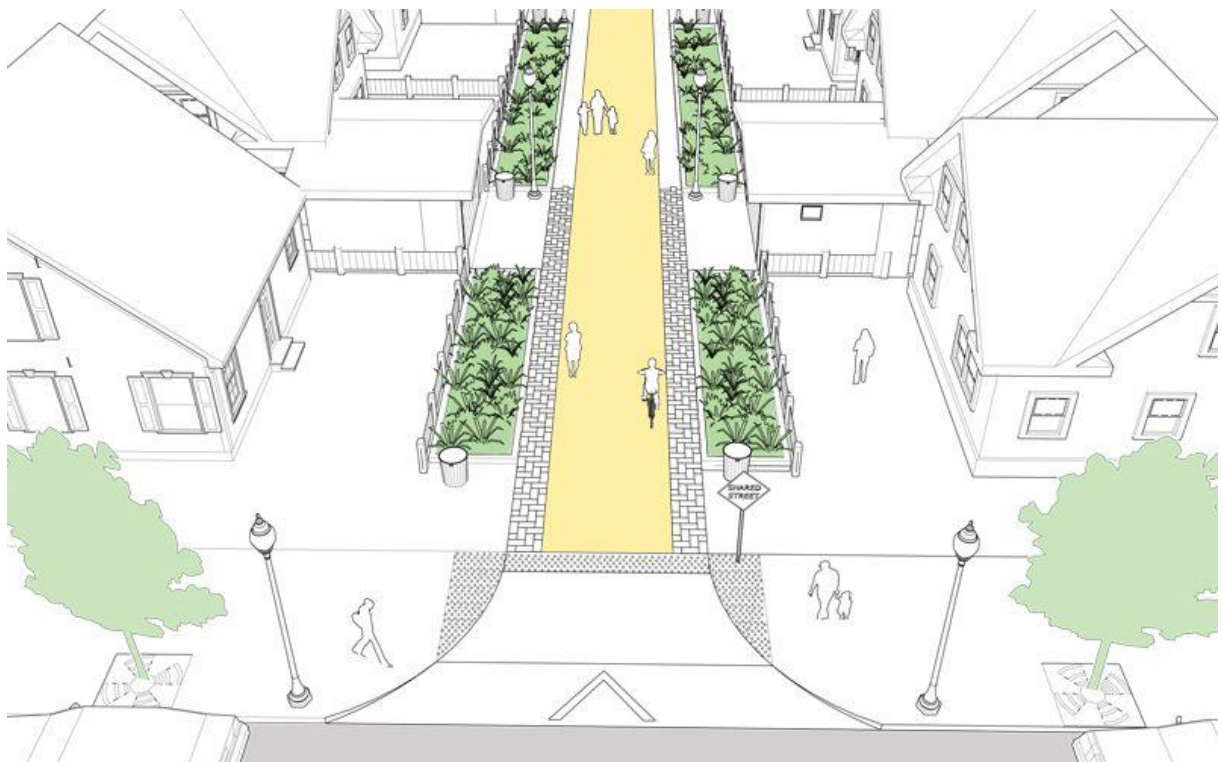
Configuração americana tipo *Green Alley* (Rua de Jardim)
